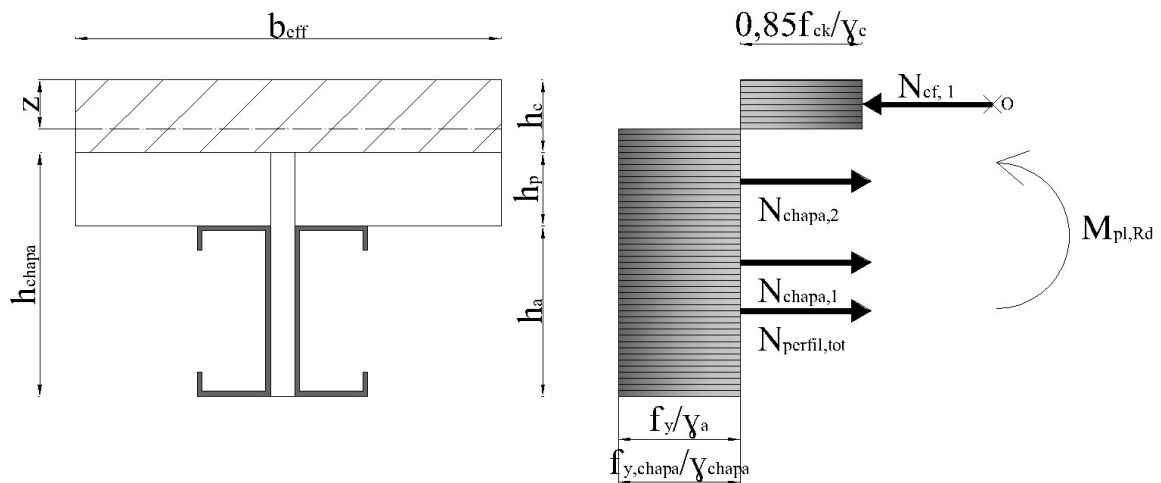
Caso B.1: eixo neutro na laje de betão.
